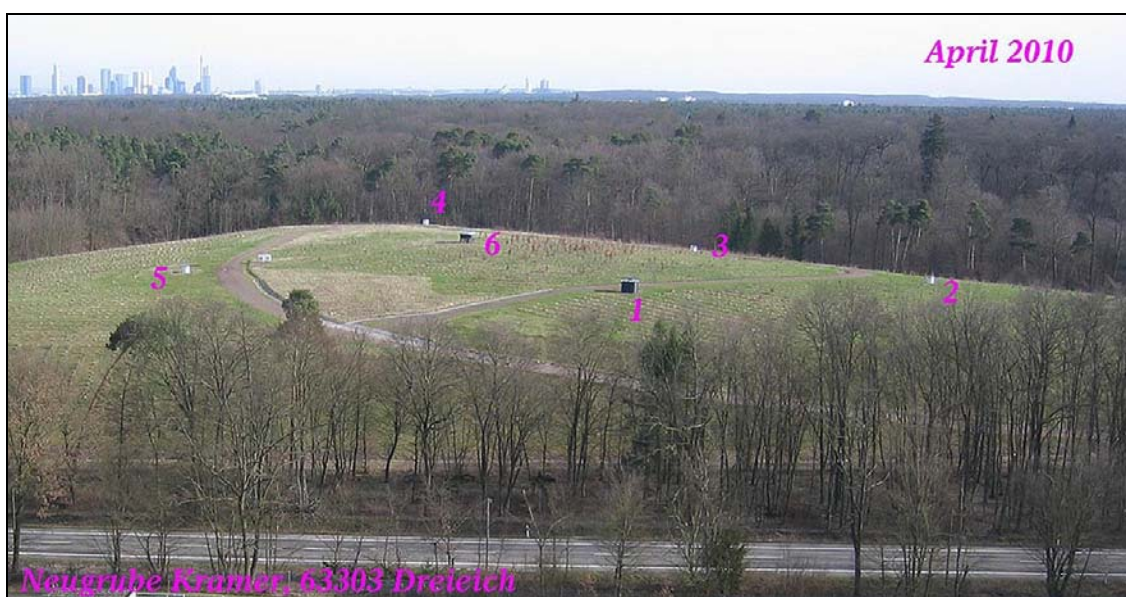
Grundstück Grube Kramer mit Lage der Gasbrunnen
